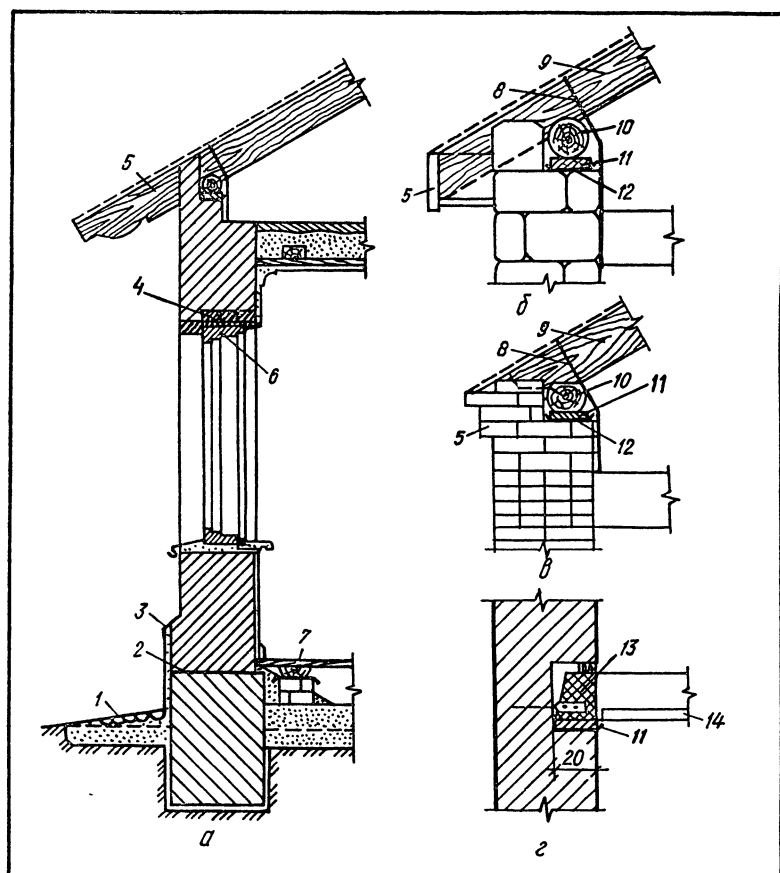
Конструктивные решения стен сплошной кладки из каменных материалов (кирпича, бута, пиленого известняка и др.):
